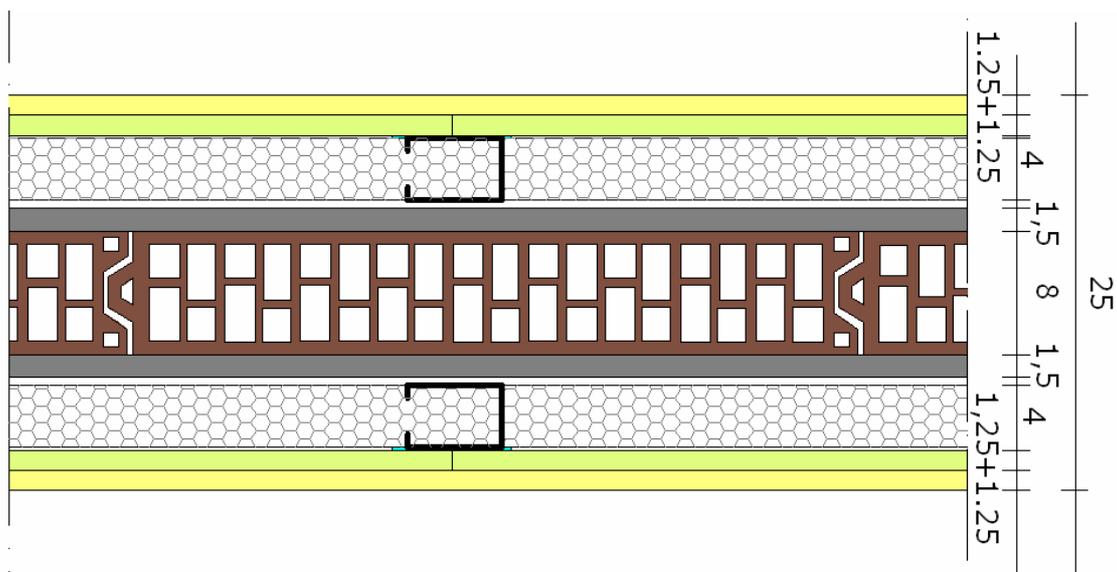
Parete di divisione tra camere da letto contrapposte
